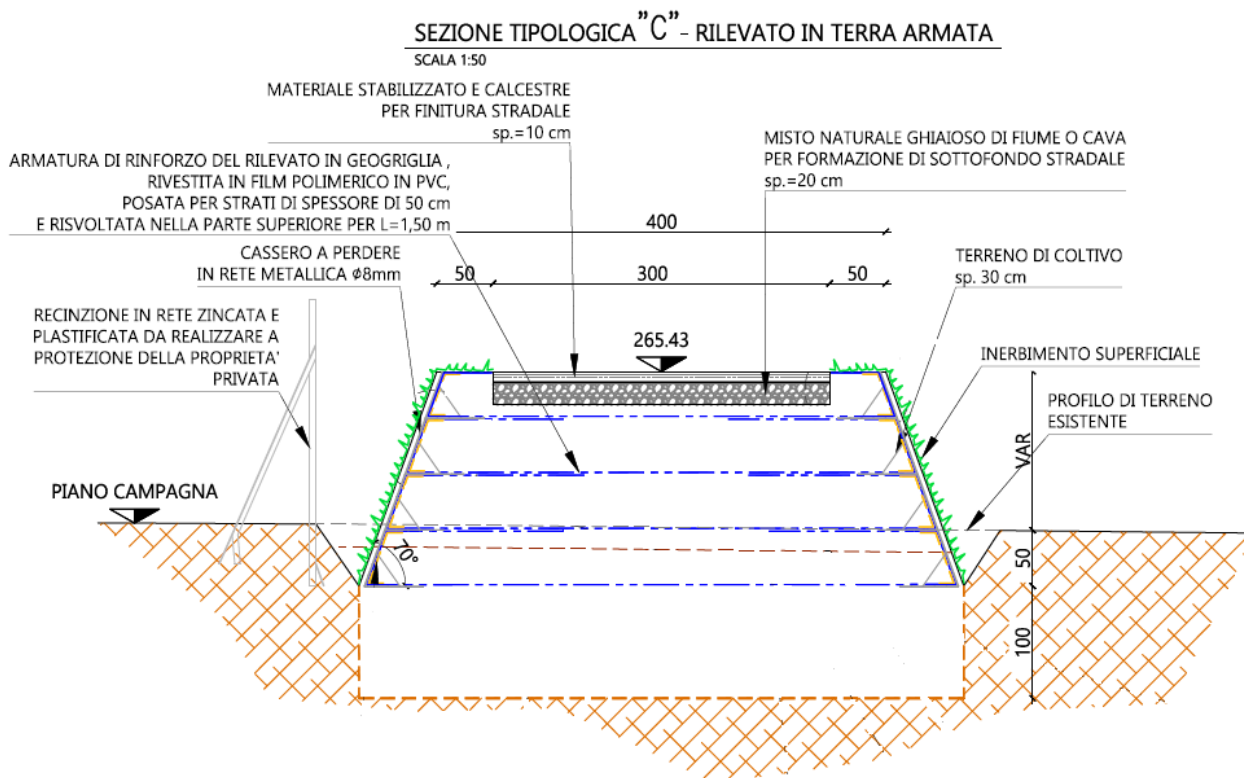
argine nord, soluzione in terra armata prevista dal progetto esecutivo approvato
